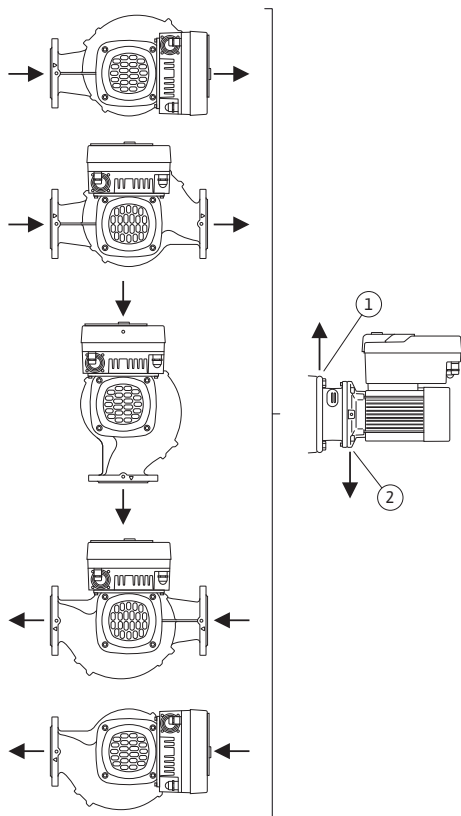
Tilladte installationspositioner med horisontal motoraksel
